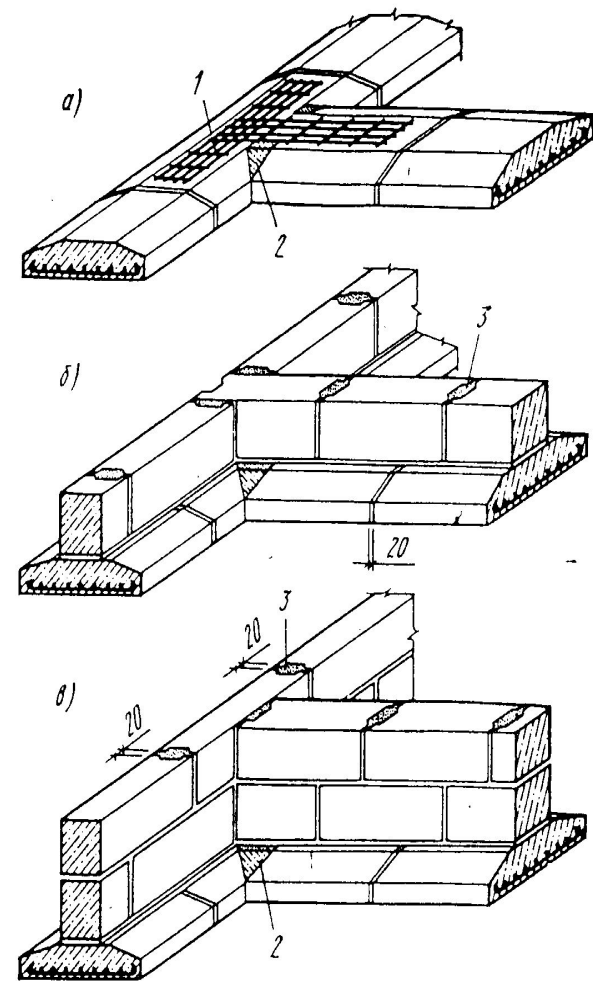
Сопряжение фундаментов продольных и поперечных стен:
